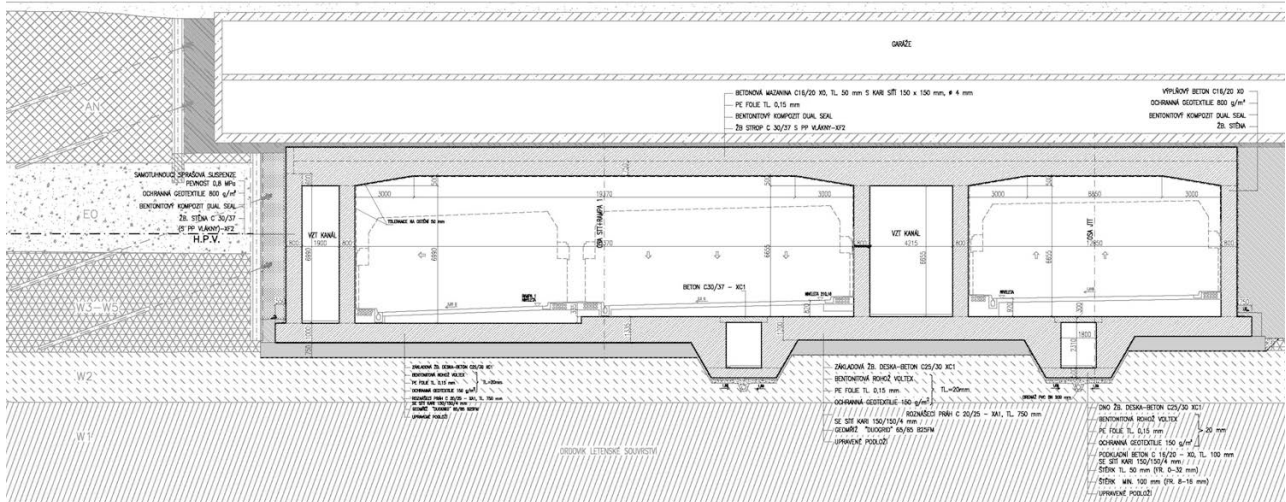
TCB – Sección transversal construida mediante excavación entre pantallas.
